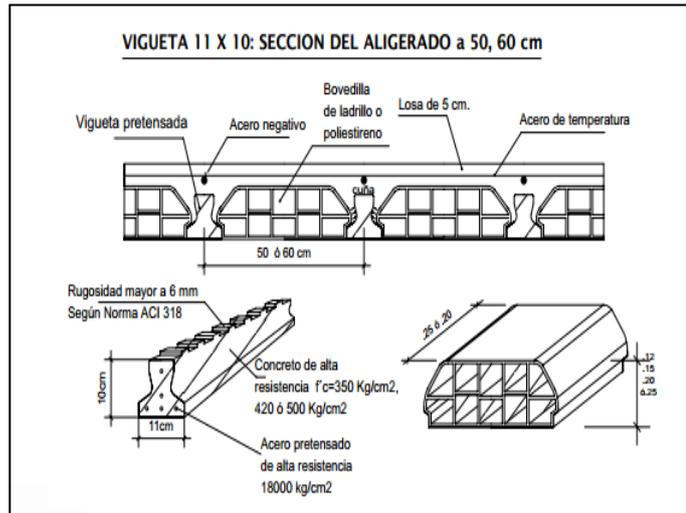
Colocación de viguetas prefabricadas ALITEC
